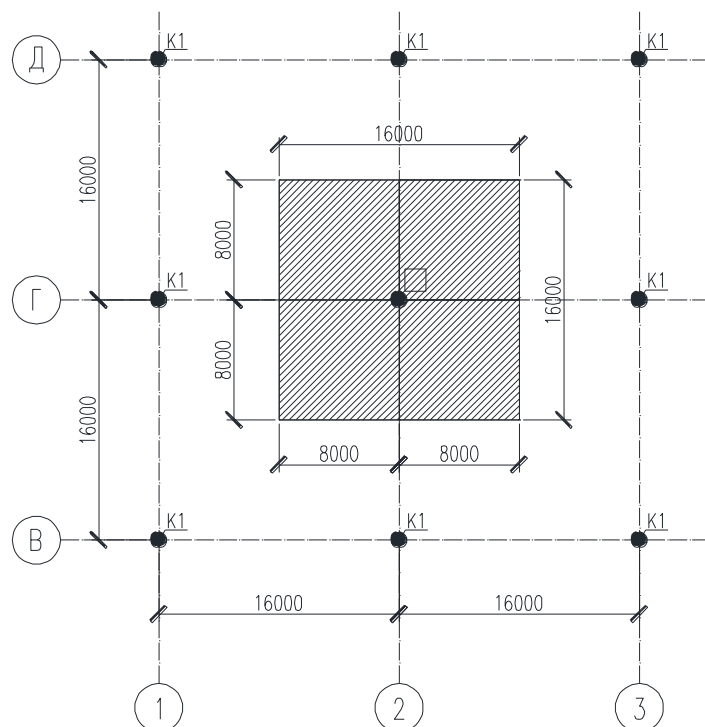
Грузовая площадь при расчете фундамента под колонну здания
